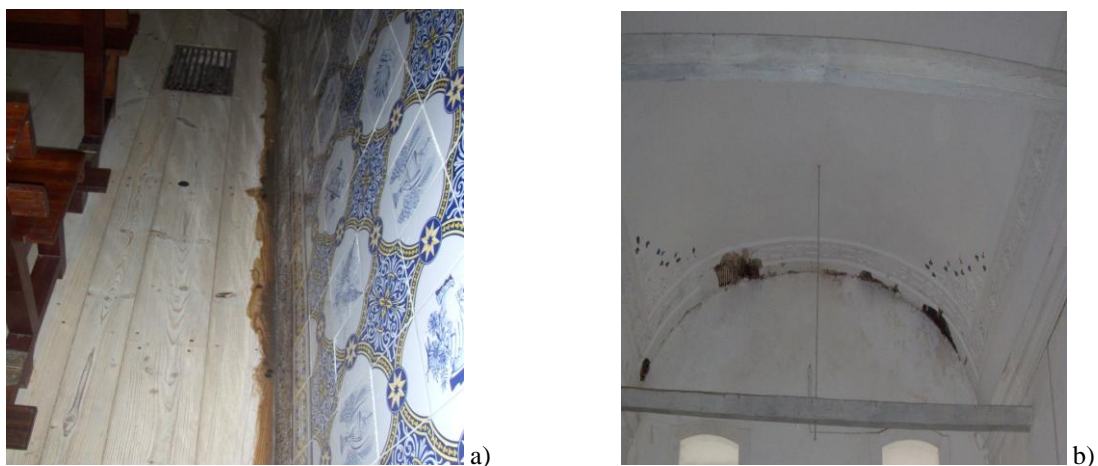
a) Pavimento em madeira; b) Teto fasquiado e estuque.
